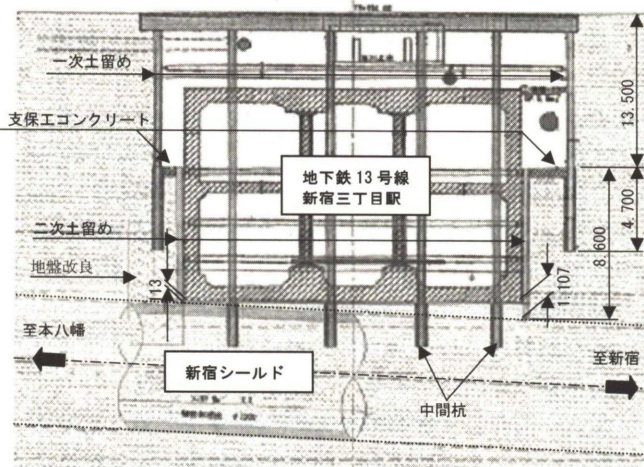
新宿シールド交差部標準断面図 (A-A断面)
